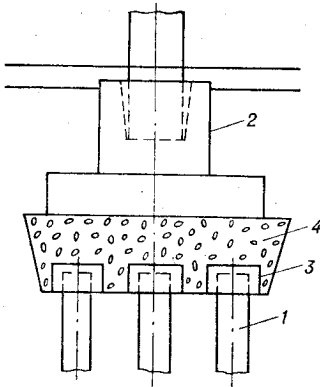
Пальовий фундамент з проміжною подушкою:
